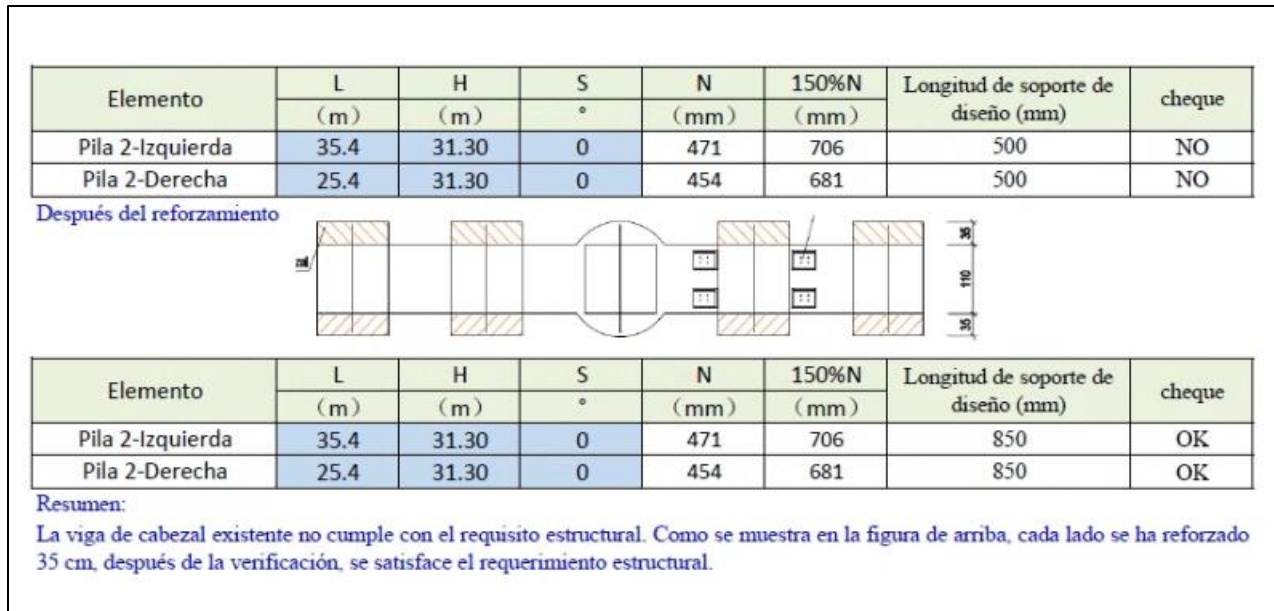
Extracto de la memoria de cálculo donde se revisa la longitud de asiento en las pilas del puente existente sobre el río Destierro.
